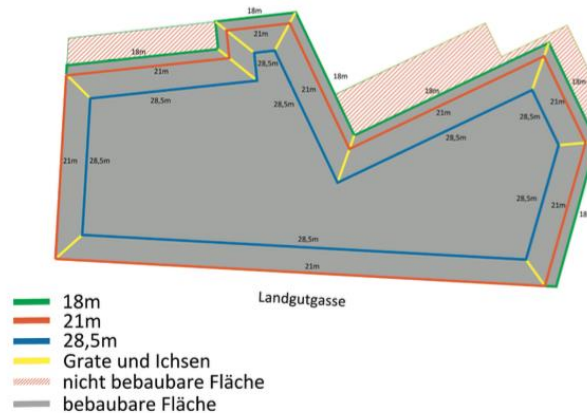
Bebaubare Flächen und Gebäudehöhen – Quelle: Stadt Wien
